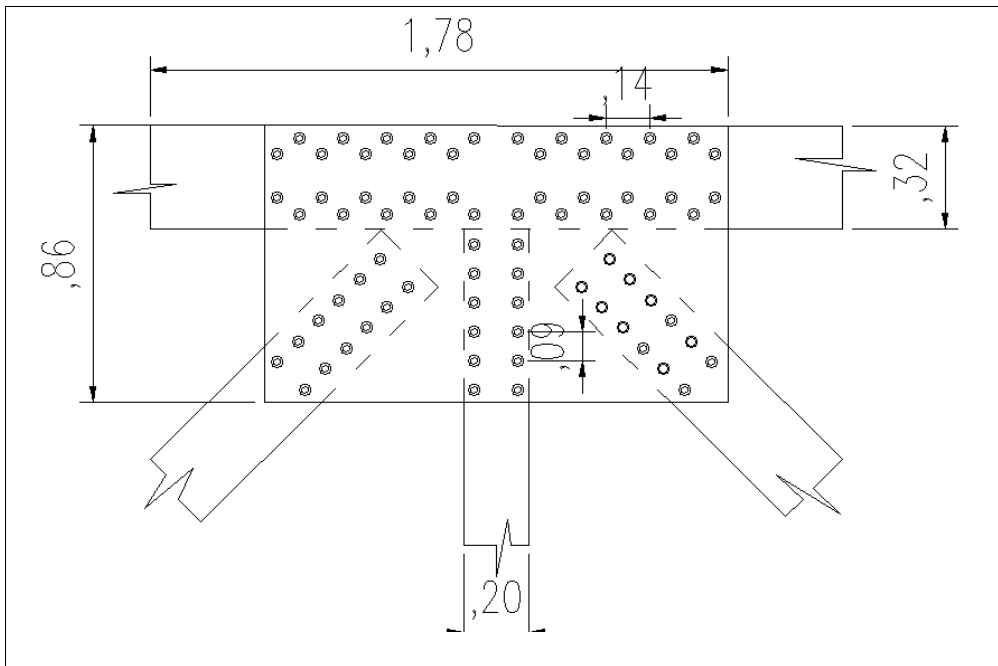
Conexión TIPO III, Puente 1. Fuente (Autores).
